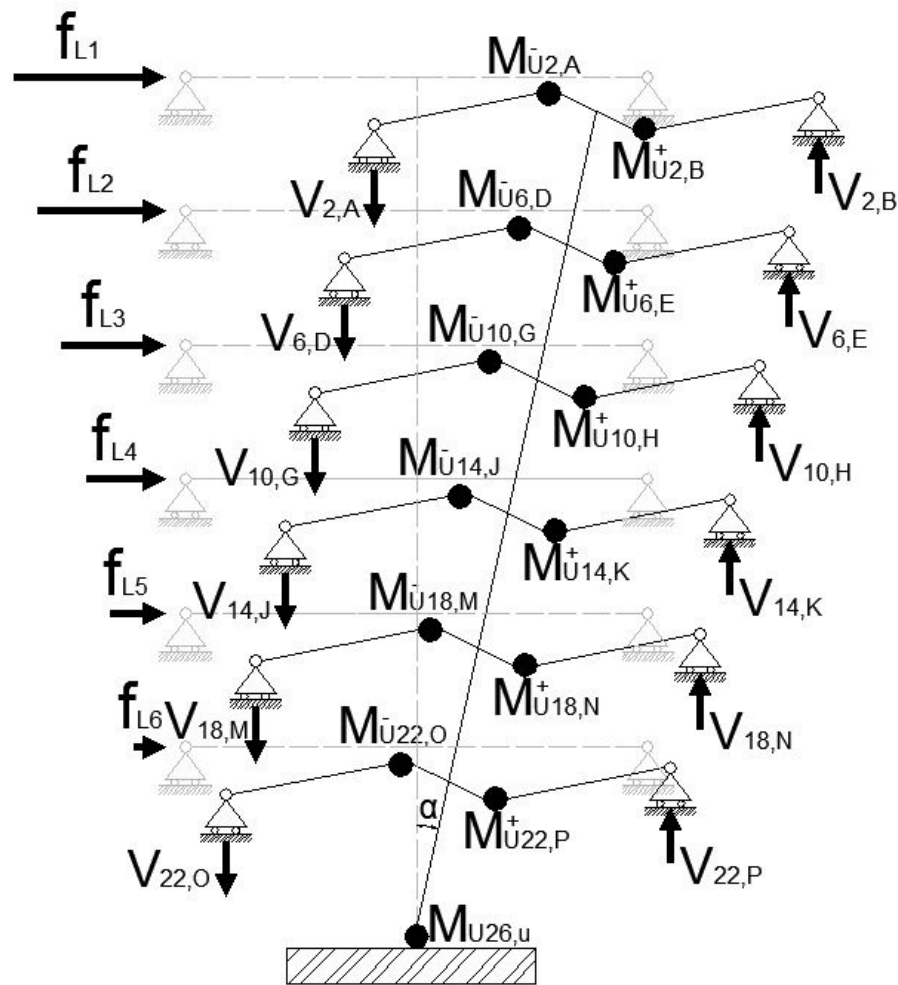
Análisis plástico de columna central del pórtico 1. Pilar 2
